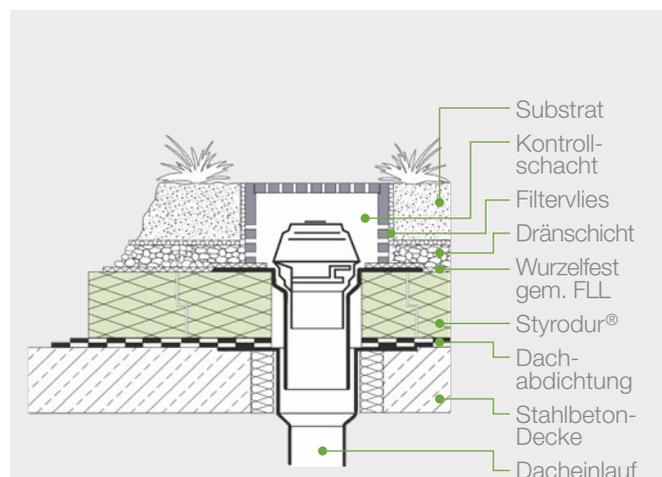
Dacheinlauf mit Kontrollschacht bei einem UK-Dach mit Intensivbegrünung und einer Sickerschicht aus Blähton.
